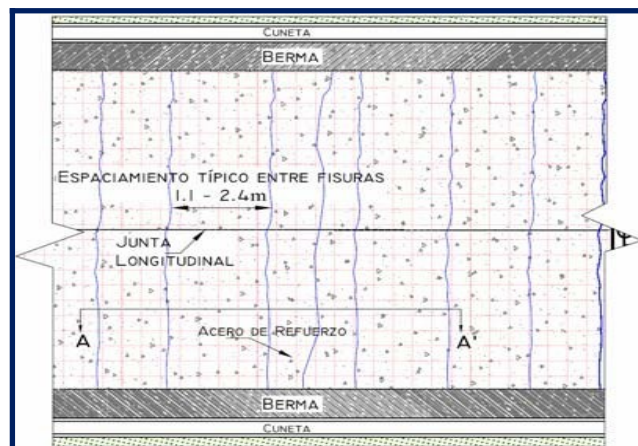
Vista típica del proceso constructivo de losas continuamente reforzada
